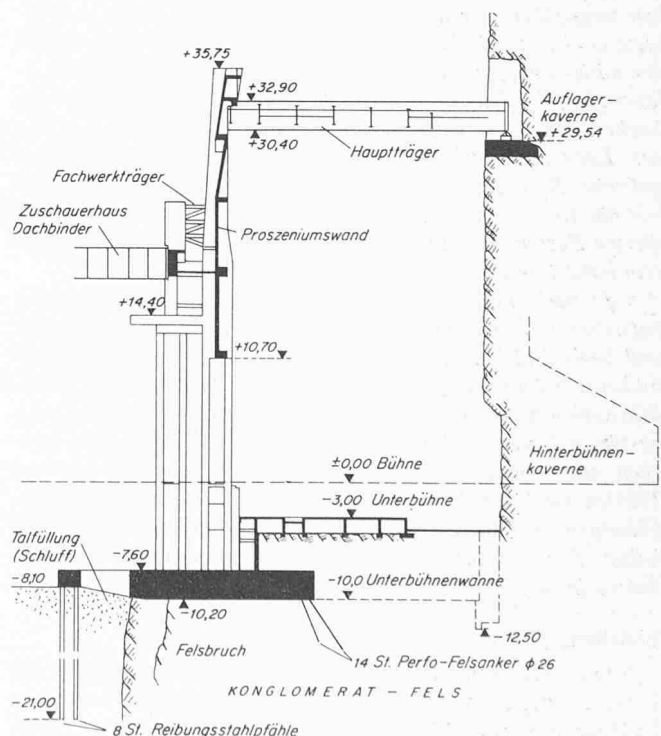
(rechts). Schnitt durch das Bühnenhaus
